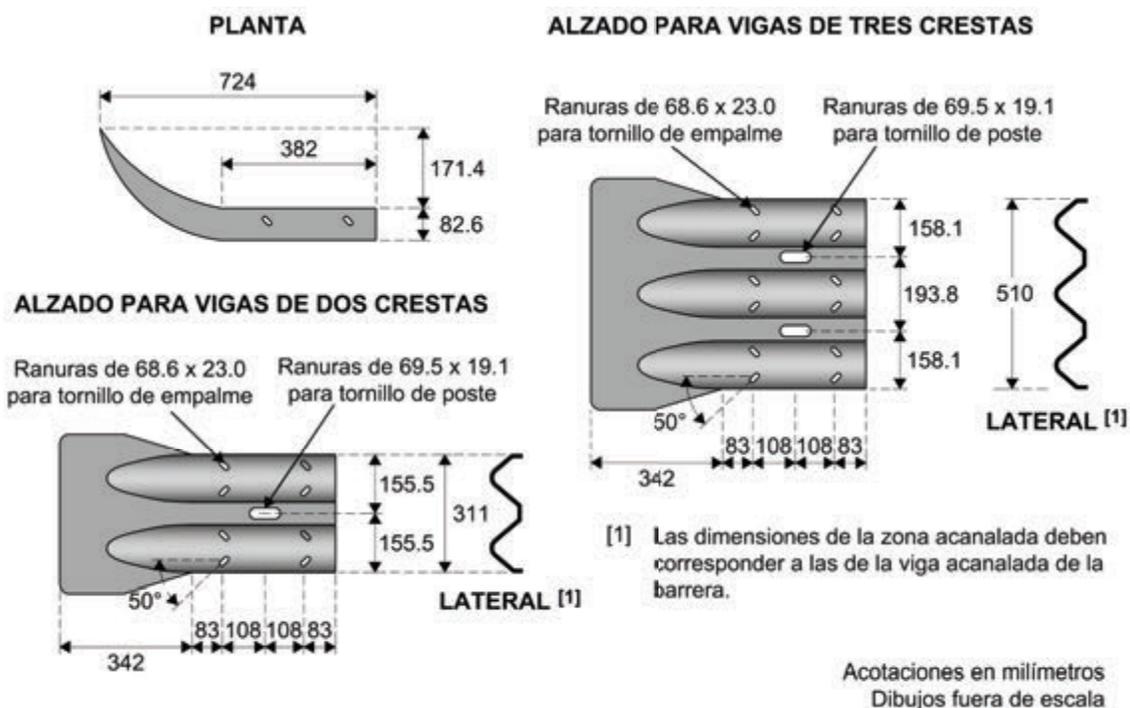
Secciones terminales Sencillas para vigas acanaladas de dos y tres crestas (OD-4.4.2/S)
